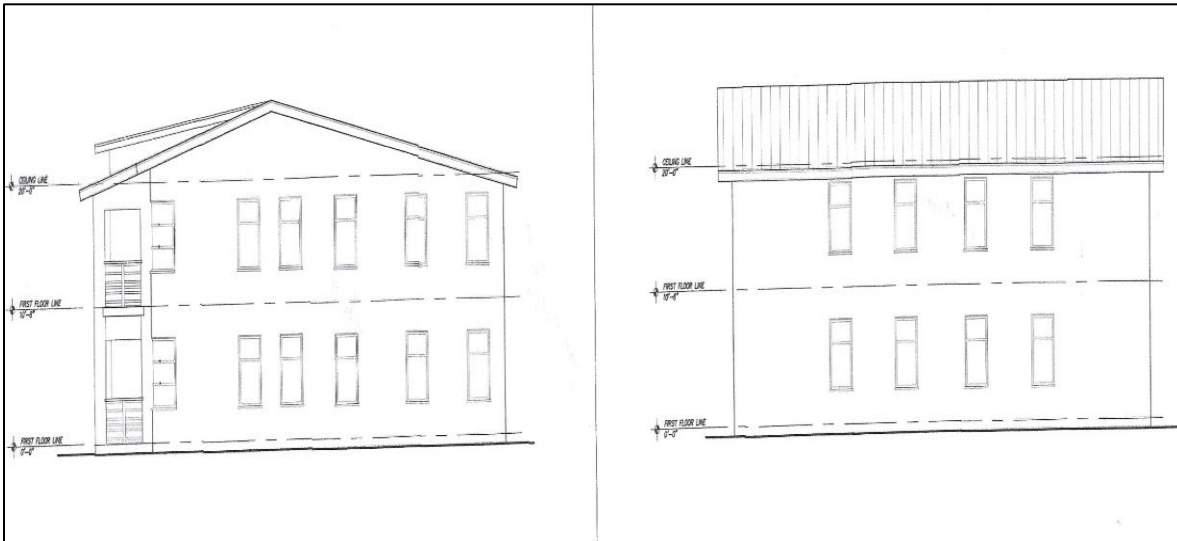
Vista Lateral Derecho Apartamentos Reef (Ver Anexo 14.6 Planos)- 2024
